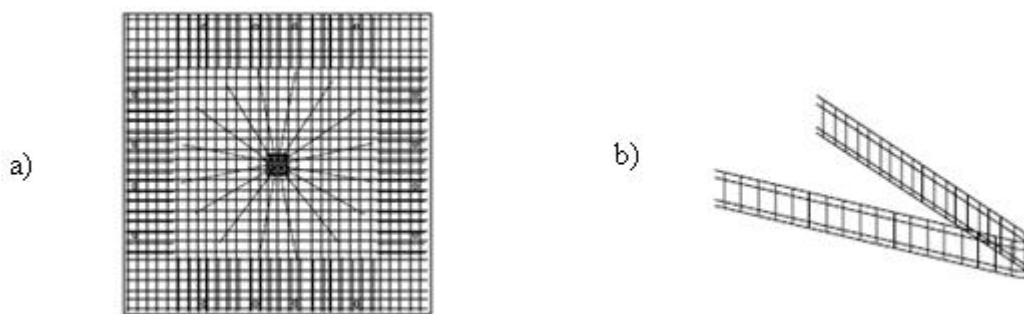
Armadura "Riss Star": a) Disposição em planta; b) Pormenor (Regan, 1993)
